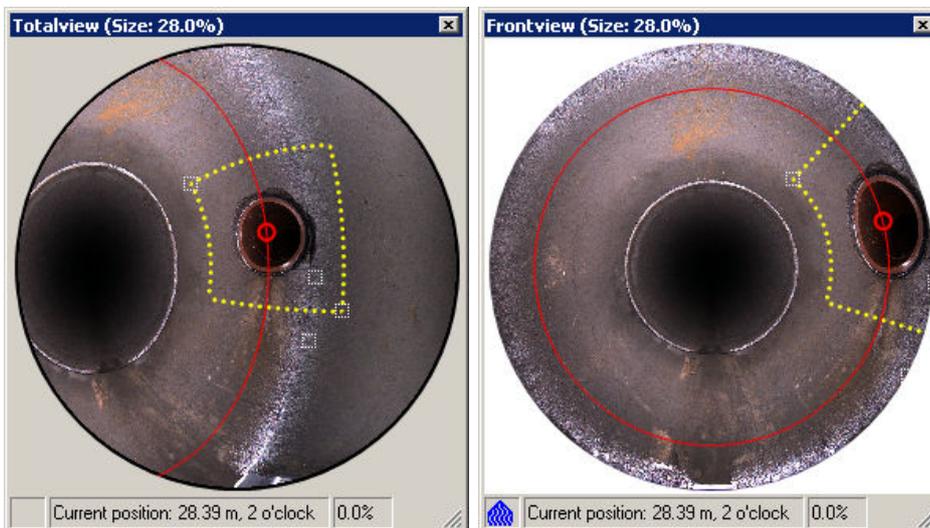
À gauche : Vues de face et arrière combinées en tant que vue totale. À droite : Vue de face standard.
